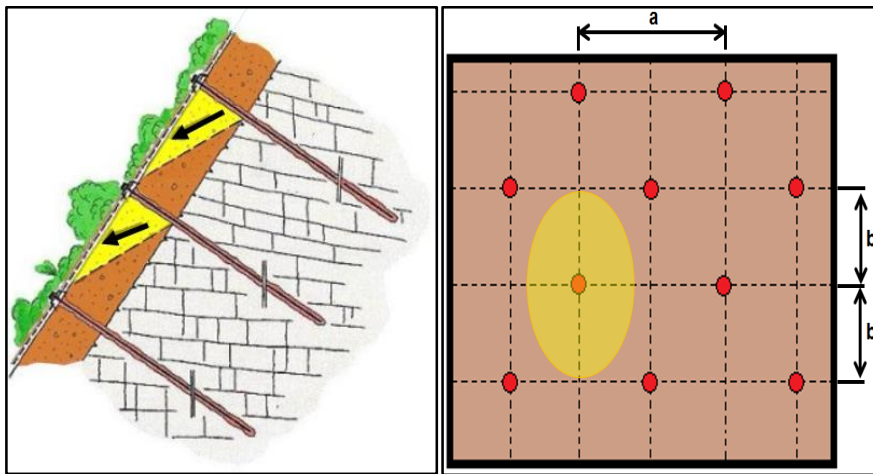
Vista lateral y esquema en planta de la zona considerada en la inestabilidad local entre pernos de anclaje. (Fuente: Geobrugg, 2011)
